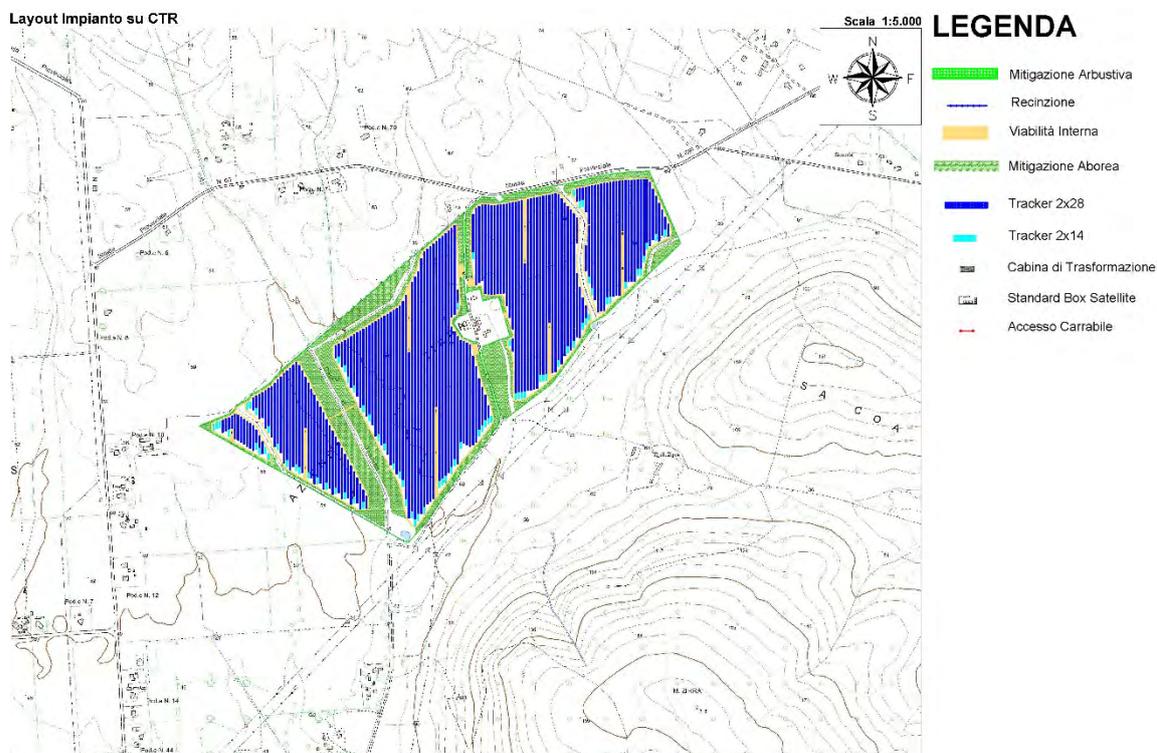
Layout dell’Impianto su C.T.R. ricadente nel territorio di Sassari
